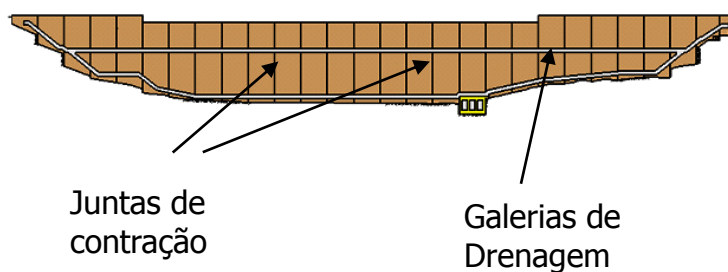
VISTA DE JUSANTE TÍPICA DE UMA BARRAGEM DE CONCRETO À GRAVIDADE
